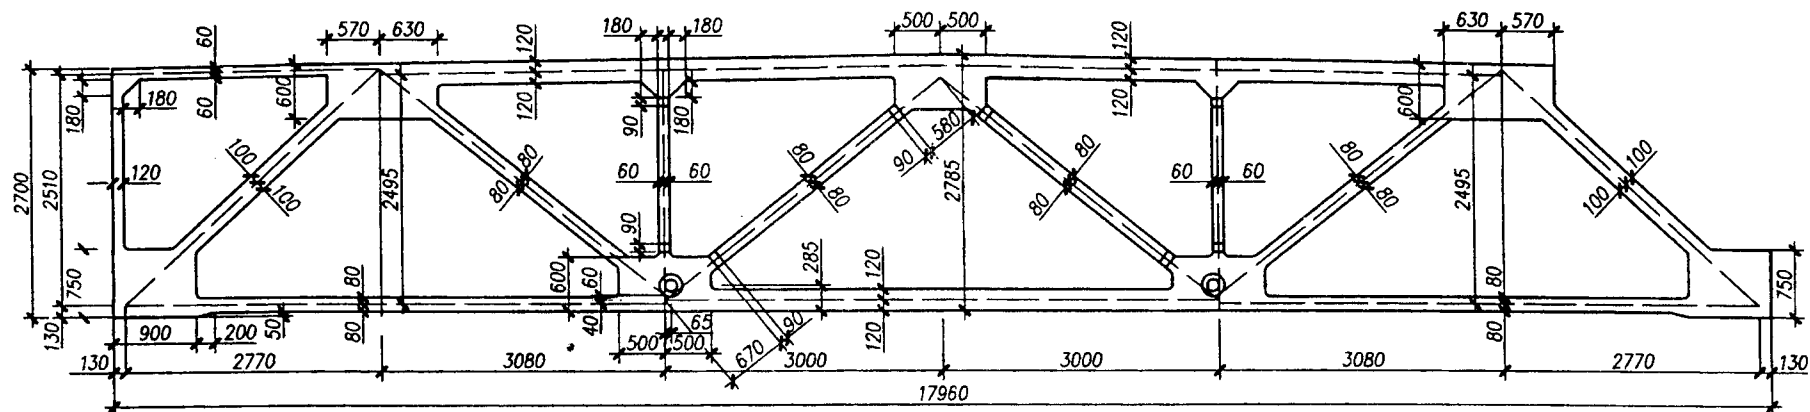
Полигональные рядовые железобетонные фермы (первого типа)
